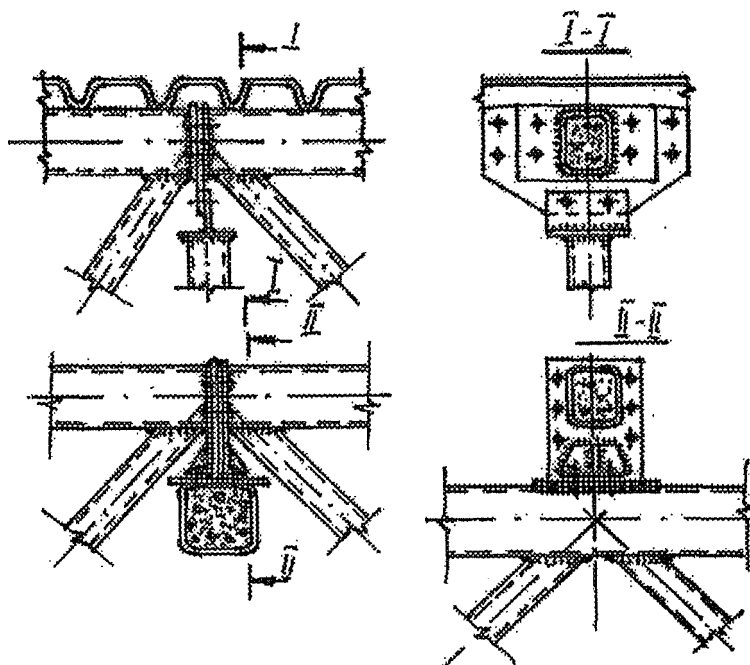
Стропильные и подстропильные металлобетонные фермы
